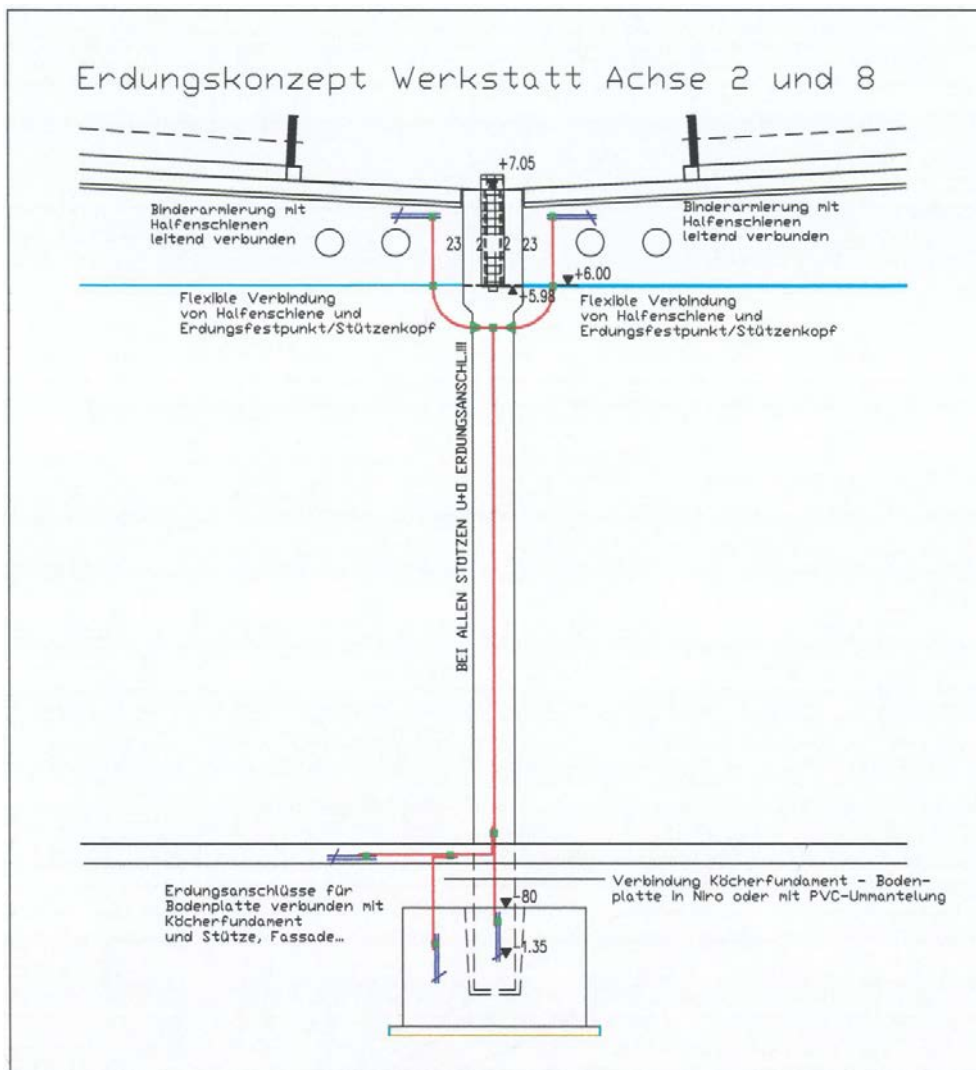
Erdungskonzept Werkstatt im Bestand (Auszug aus Plan Fundamentender UG Plan-Nr. E/J8-018.0)
